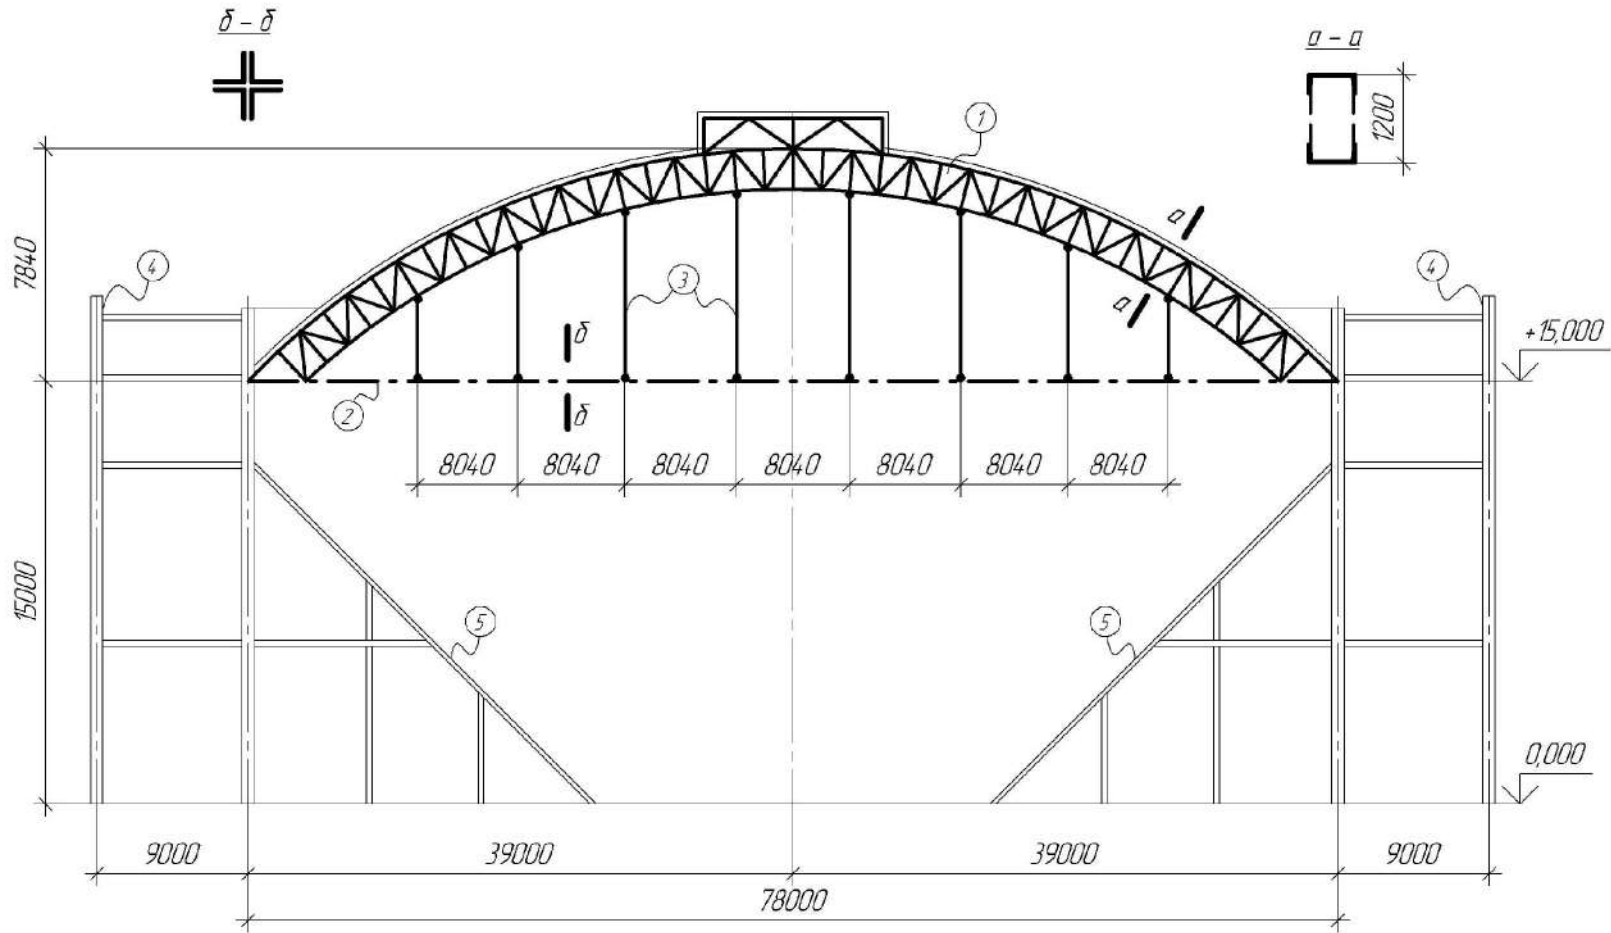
Дворец спорта в Москве (Лужники) с арочным покрытием, расположенным на высоком каркасе, с затяжками: 1 – арка большепролетная (поперечное сечение – по а-а); 2 – затяжка (поперечное сечение крестовое из 4-х уголков по б-б); 3 - подвески; 4 – железобетонный каркас вспомогательных помещений; 5 – железобетонный каркас трибун
